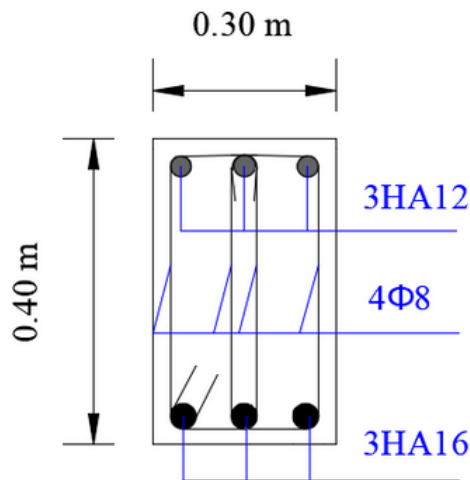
ferrailage de la poutre secondaire (30×40) en travée
